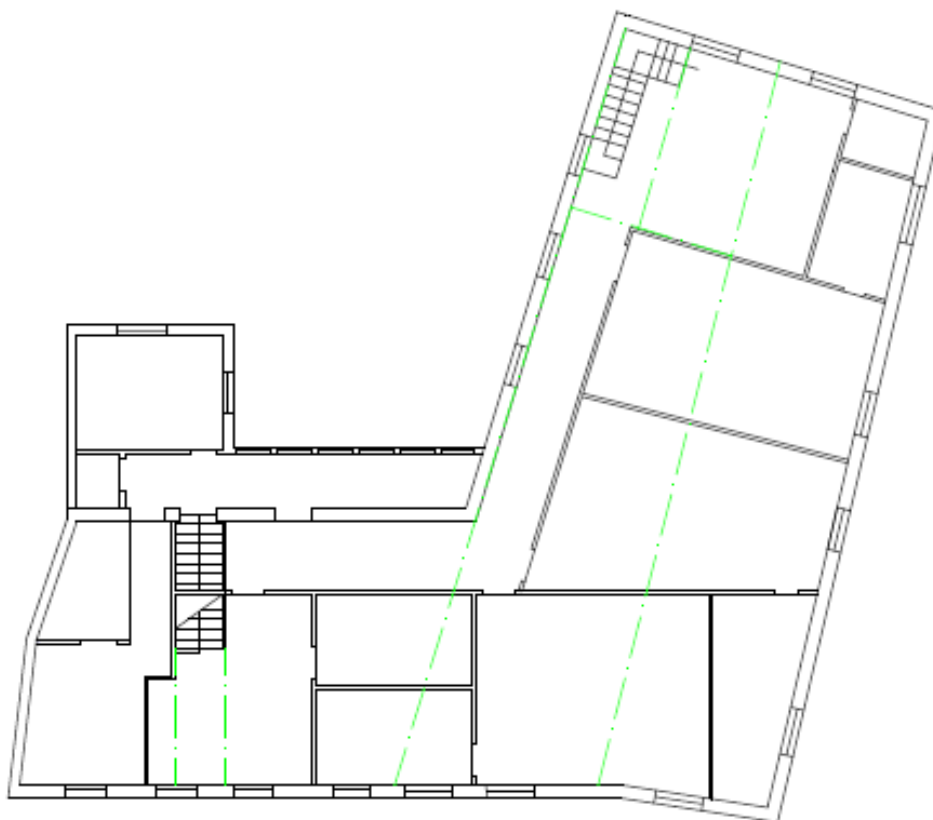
Identificação e localização (verde) de pórticos metálicos a serem introduzidos
